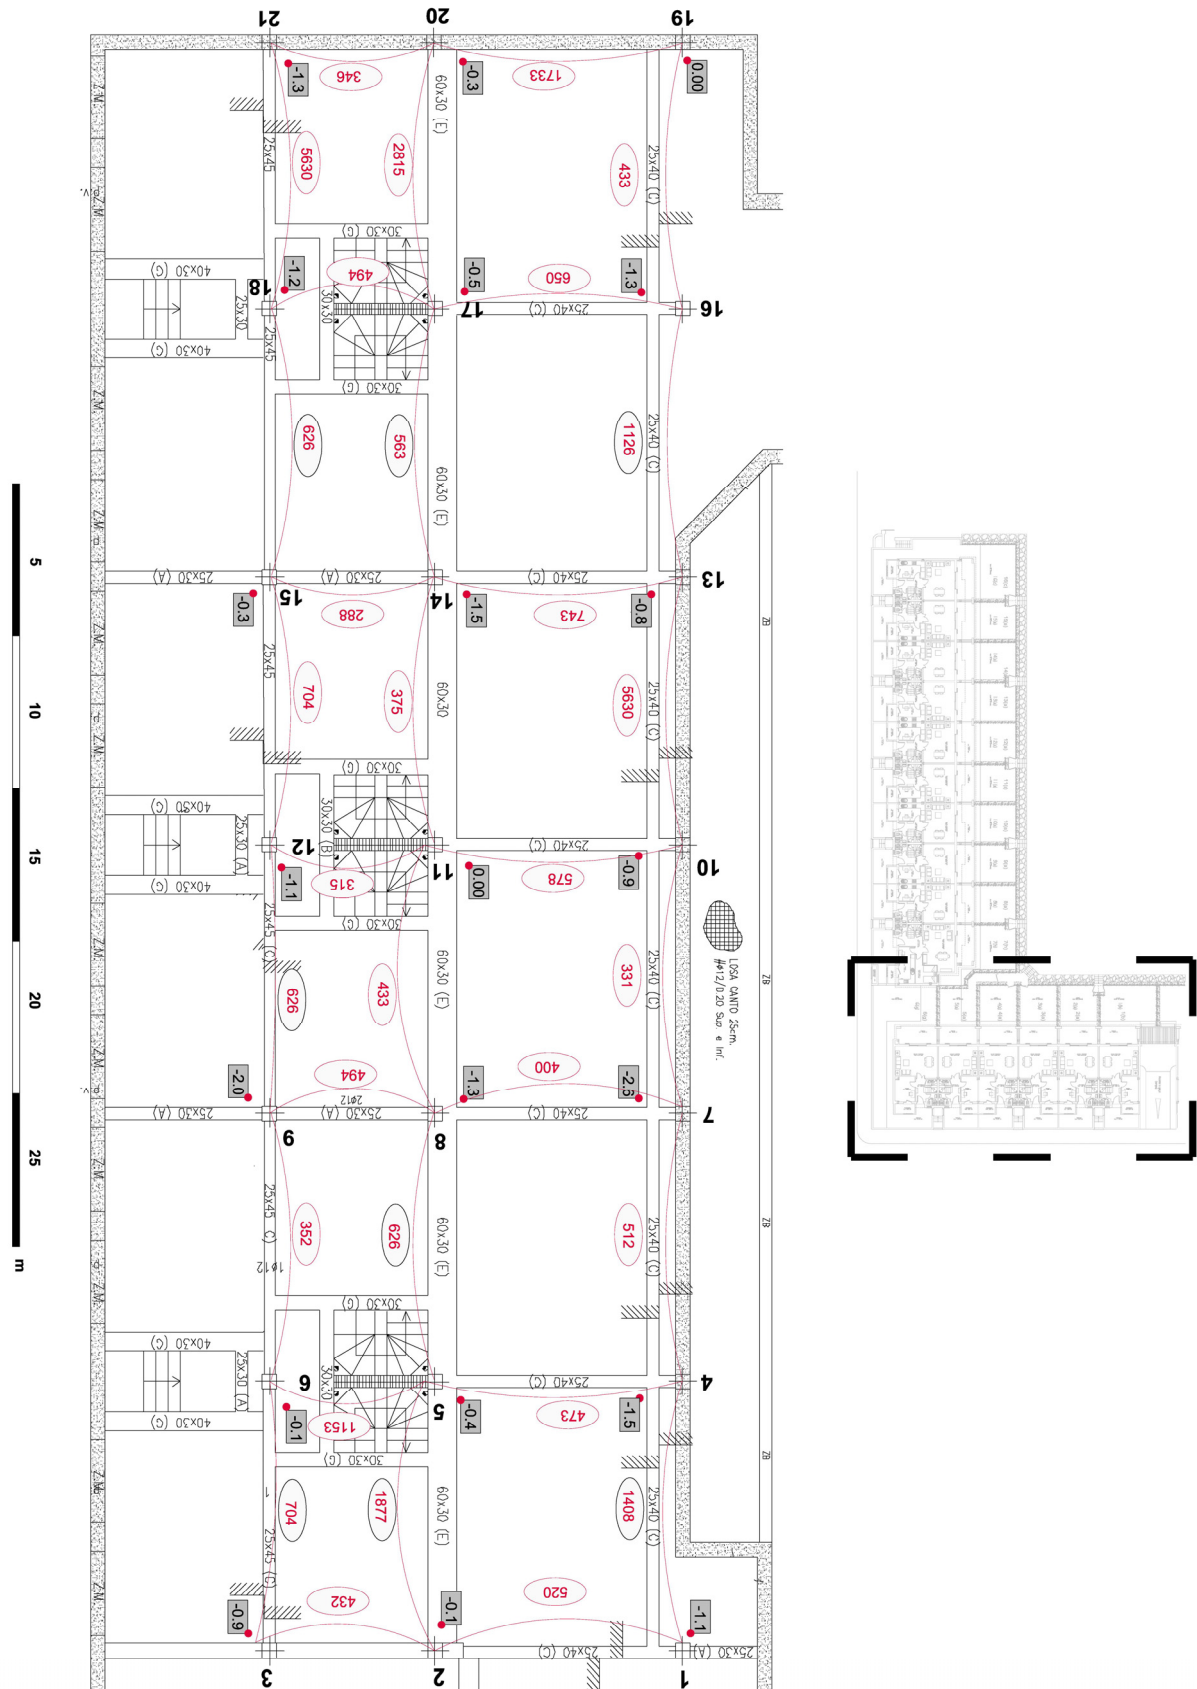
Distorsiones medidas en planta baja. Huerta de Enmedio
